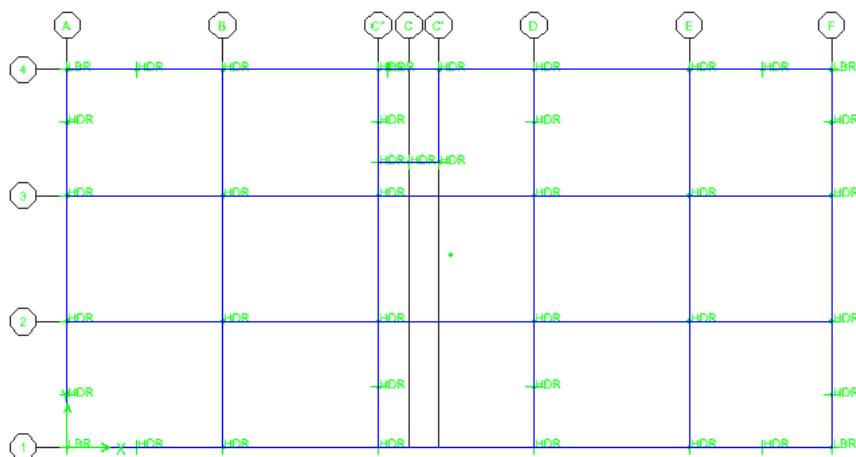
Vista en planta de la combinación de los aisladores HDR y LBR
